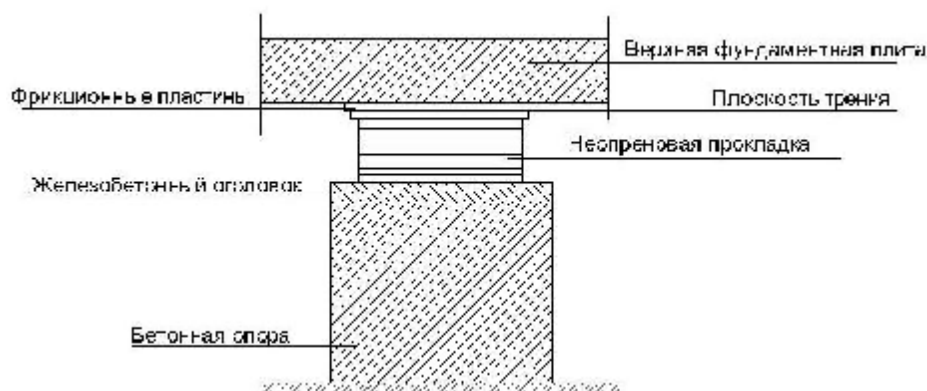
Сейсмоизолирующий фундамент фирмы SpieBatignolle.
